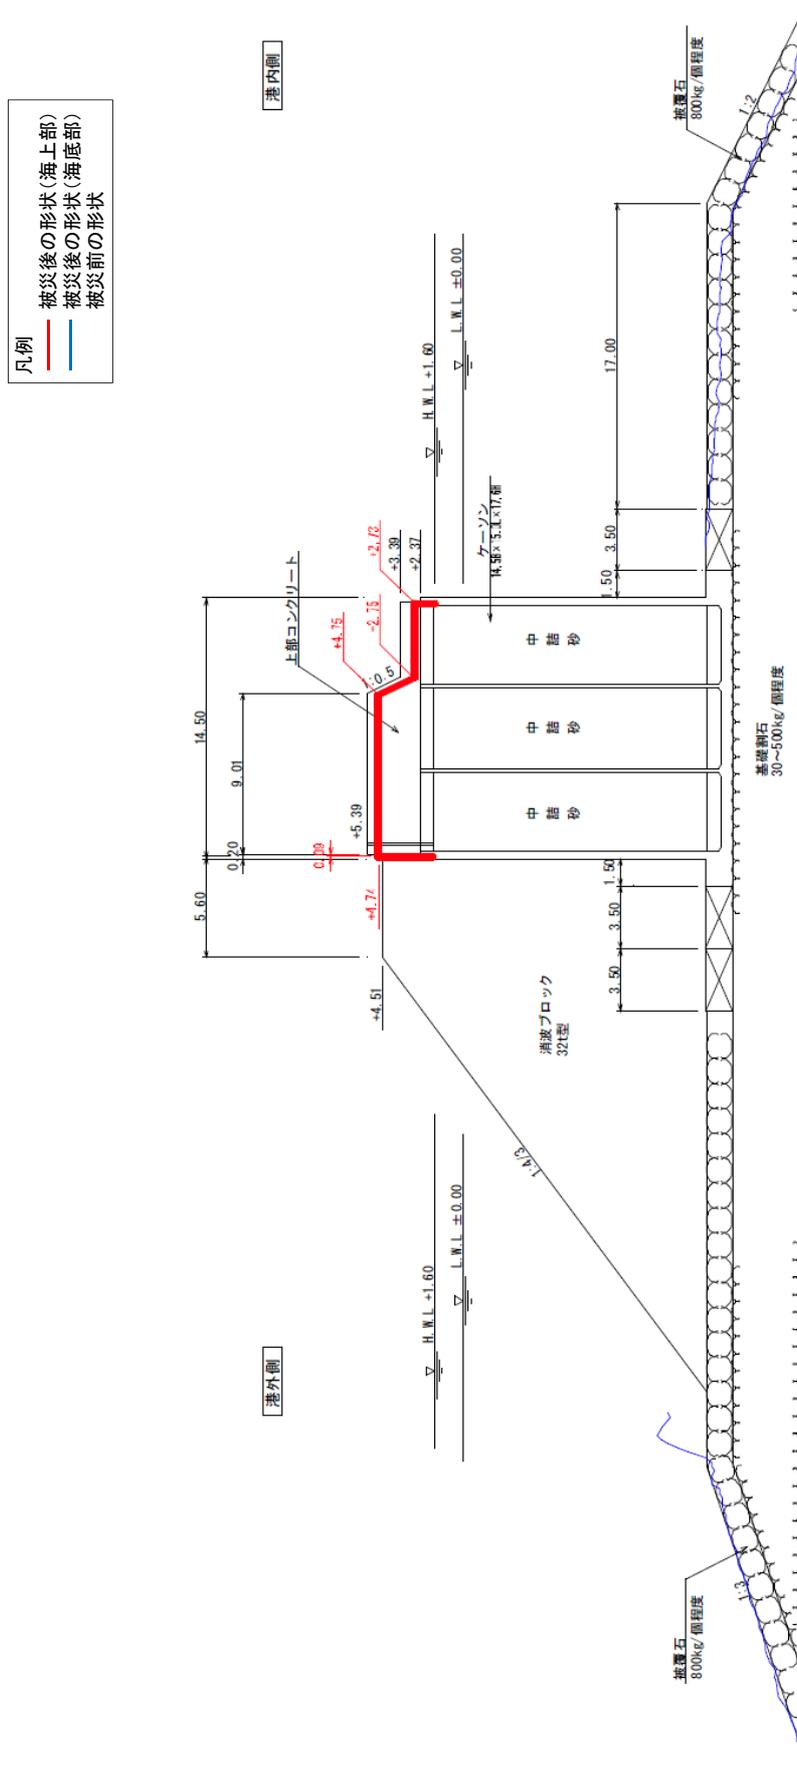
仙台港区\_外港地区\_沖防波堤の断面図 (図-3.12.13 の G-G'断面, 被災後)
